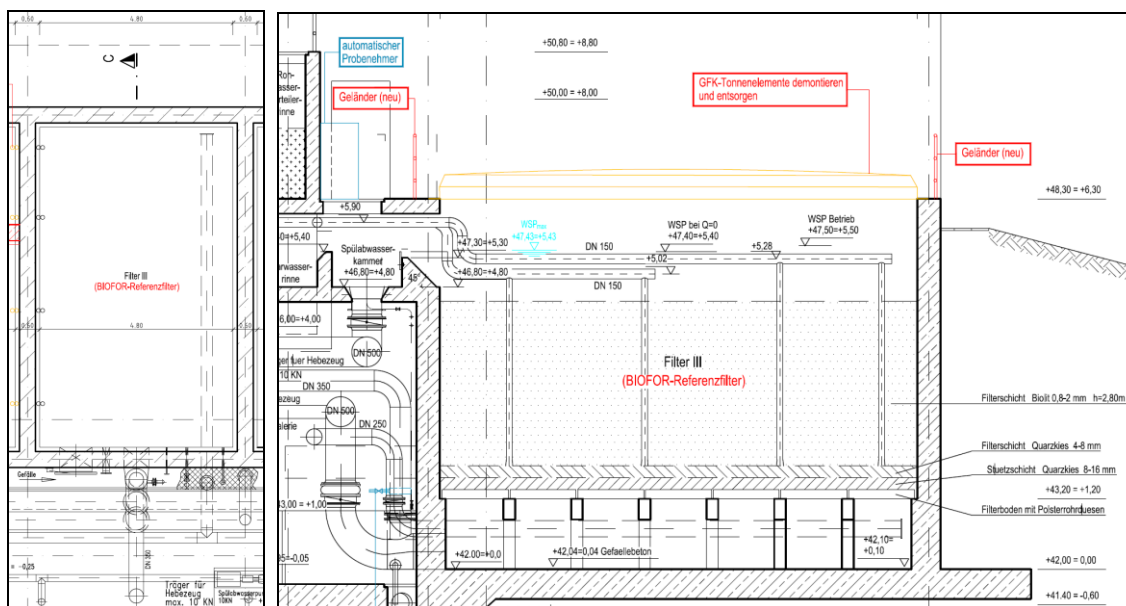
Grundriss (links) und Längsschnitt (rechts) des BIOFOR-Referenzfilters
